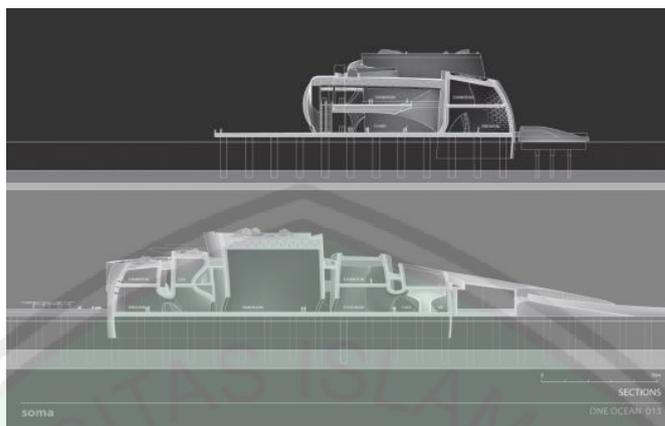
Fasad Bangunan Sumber: <http://www.evolo.us/>
